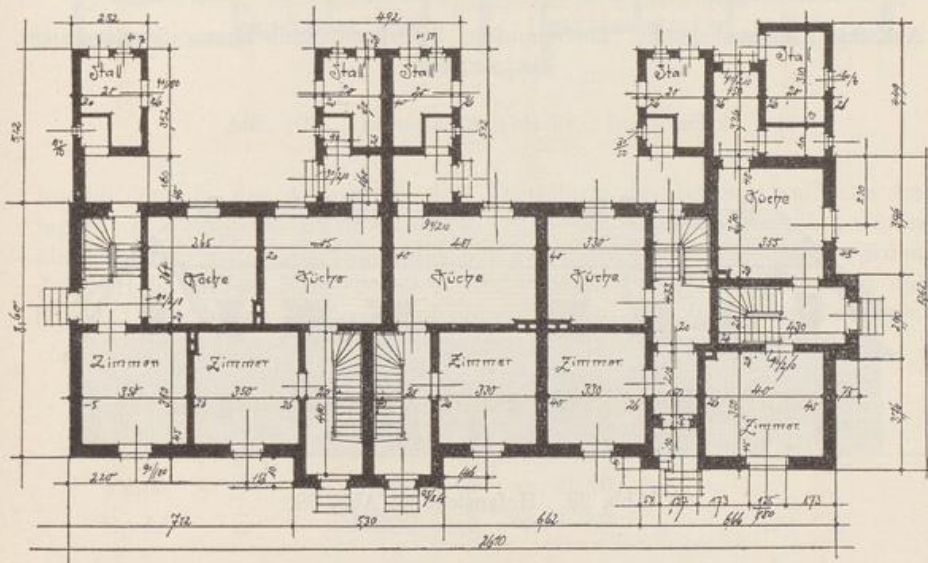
Grundriß zu Abb. 94. Erdgeschoss.
